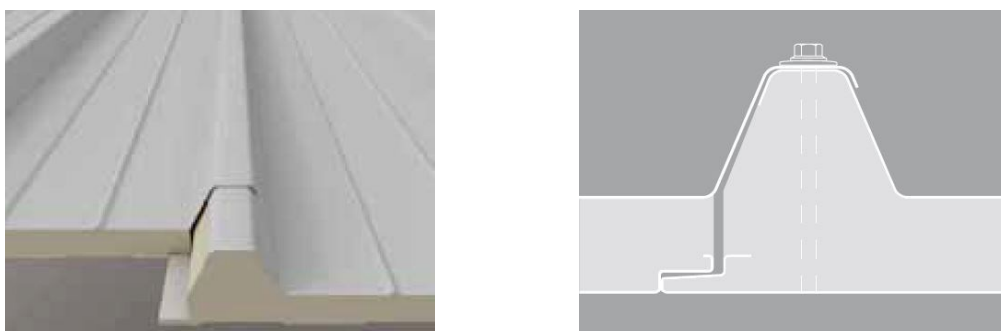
a) Pormenor da ligação de nervuras do painel sandwich ; b) Corte transversal da ligação de nervuras [11].
